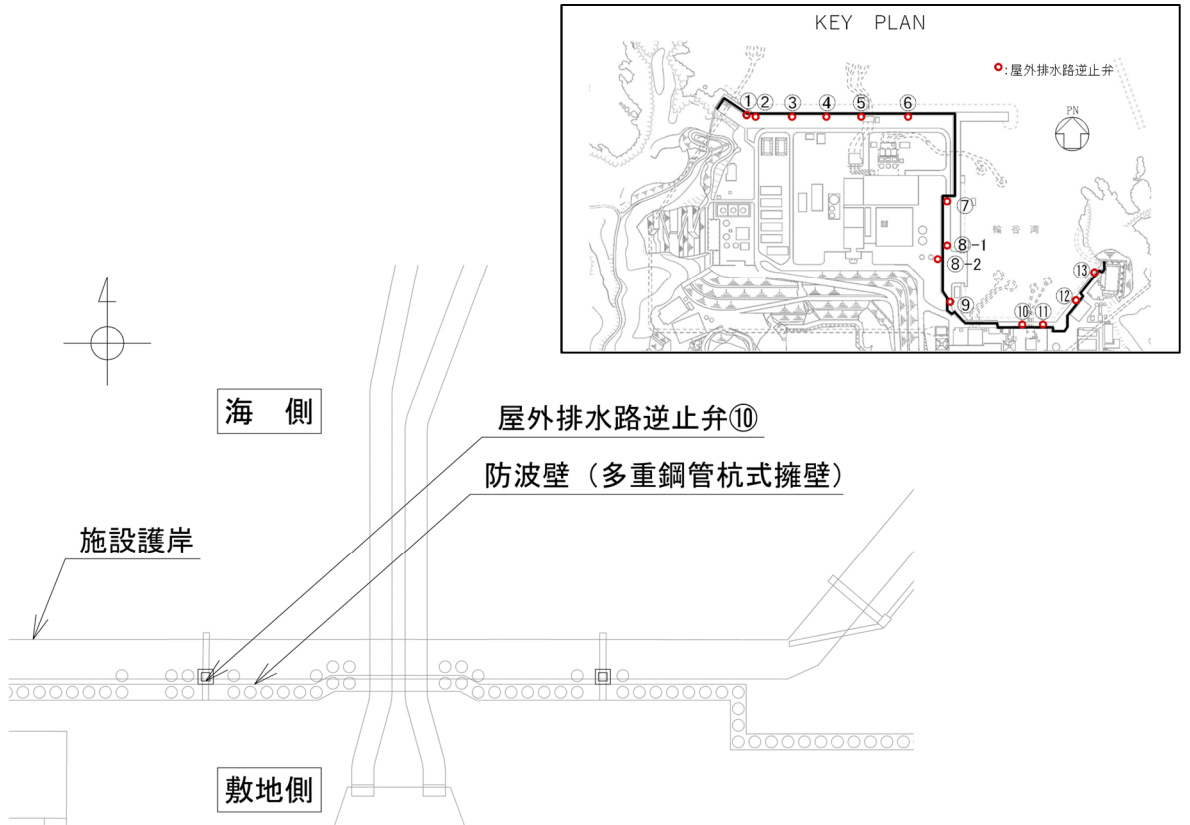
(1) 屋外排水路逆止弁⑩平面图
